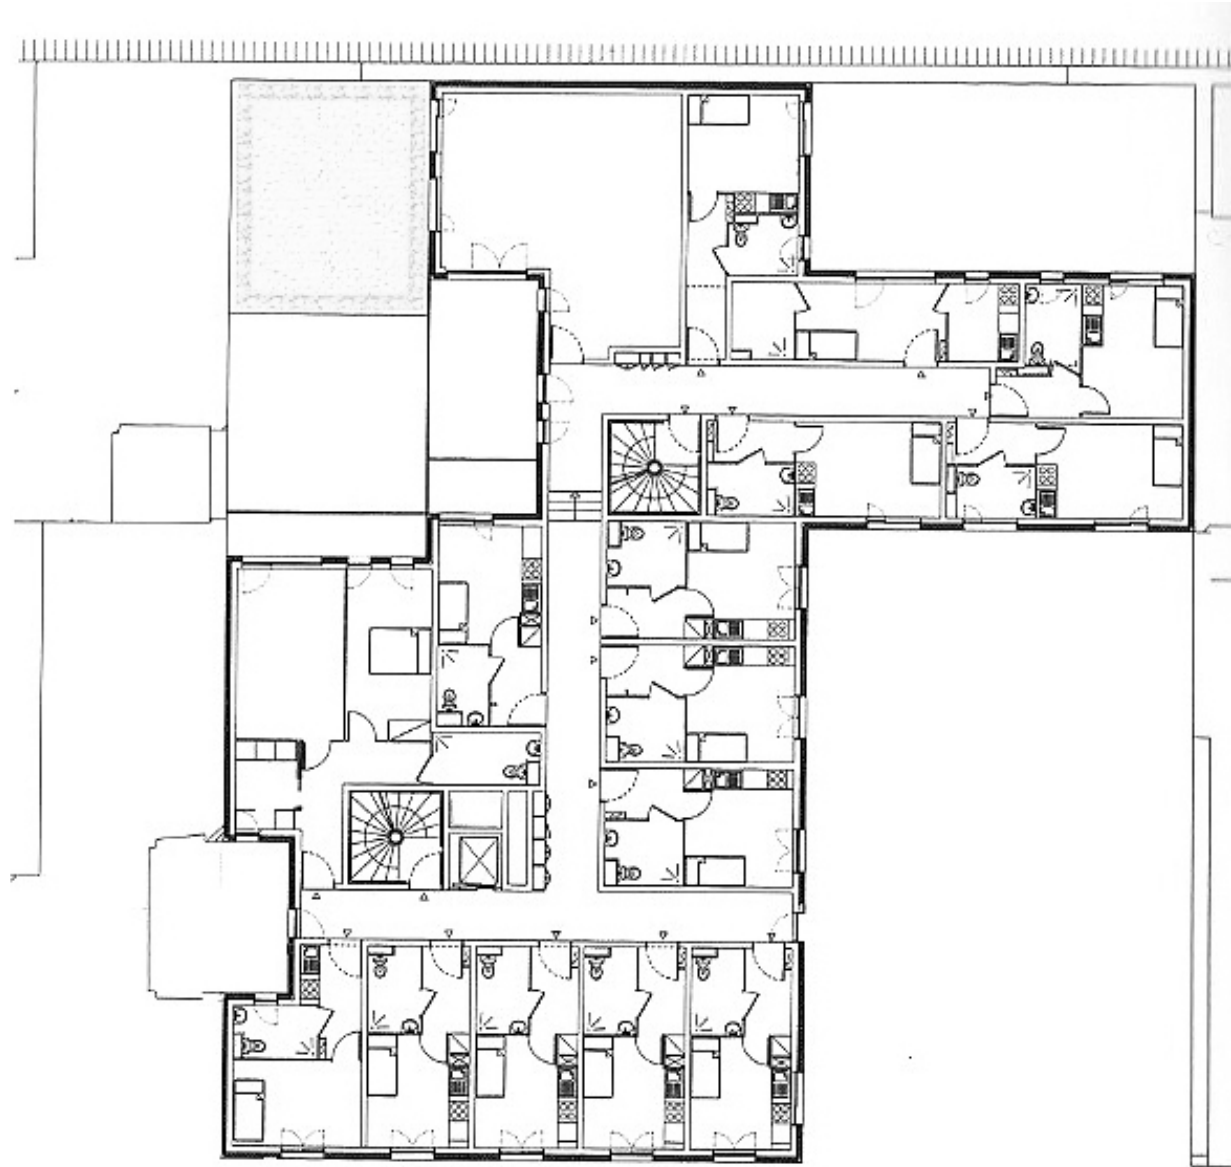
Planta tipo de las Viviendas Sociales Haussman
